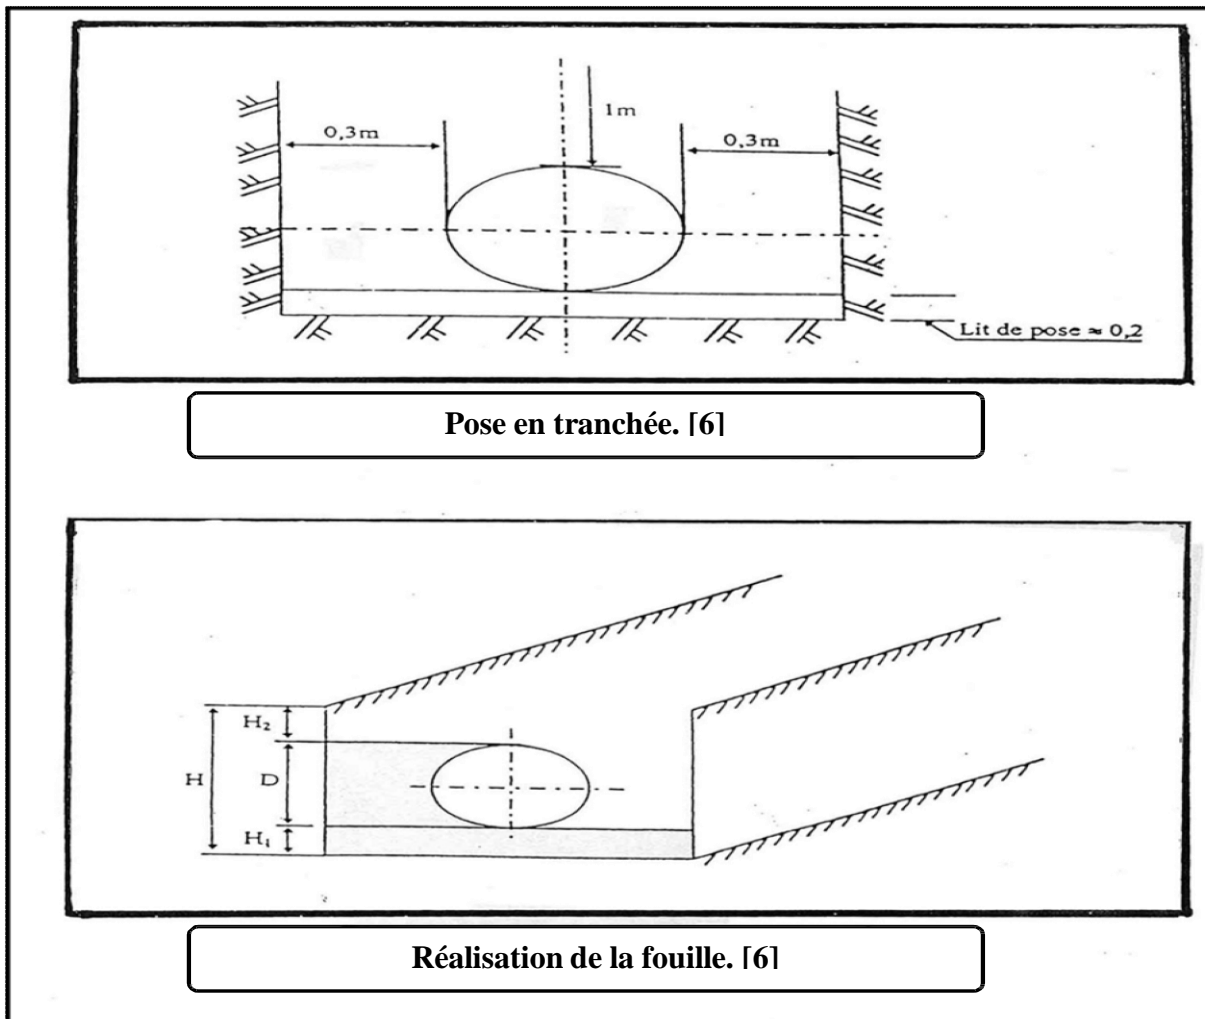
Schéma d'une tranchée avec une conduite circulaire
